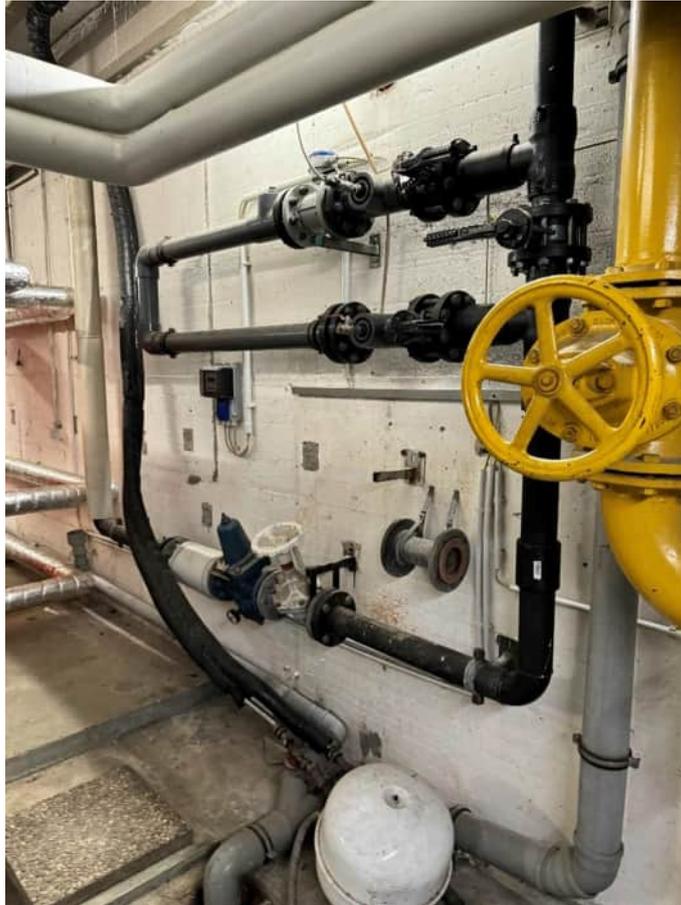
EG HA Raum TW/GAS – TW-Hausanschluss
